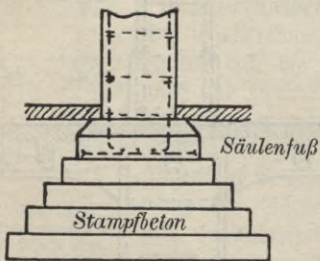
Eisenbeton-Säulenfuß auf Stampfbeton-Fundament.
